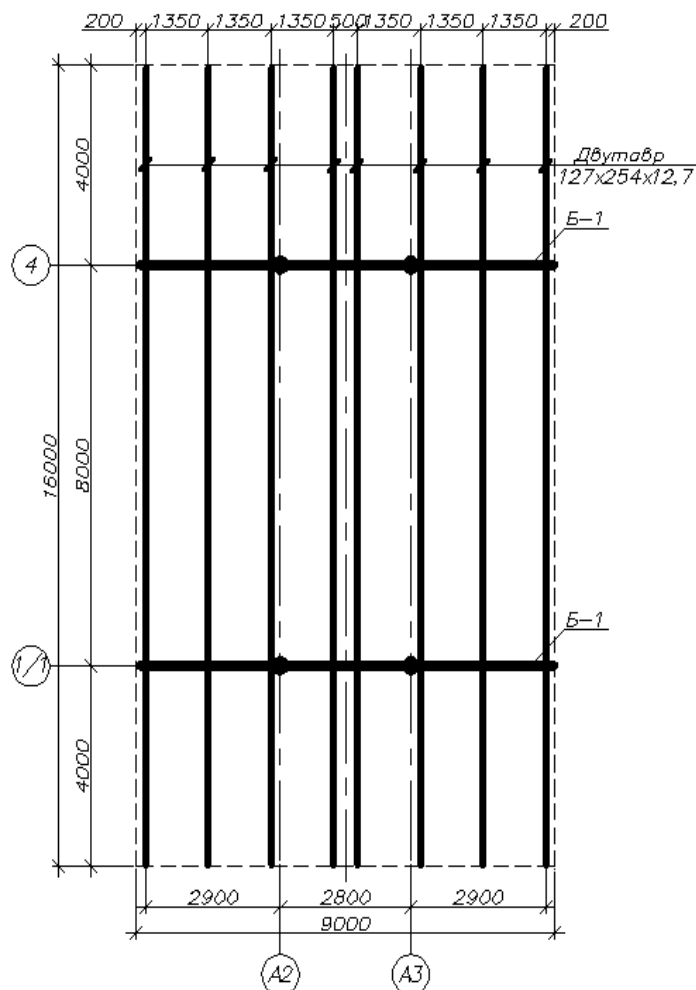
План балок покрытия и прогонов навеса над АЗС
